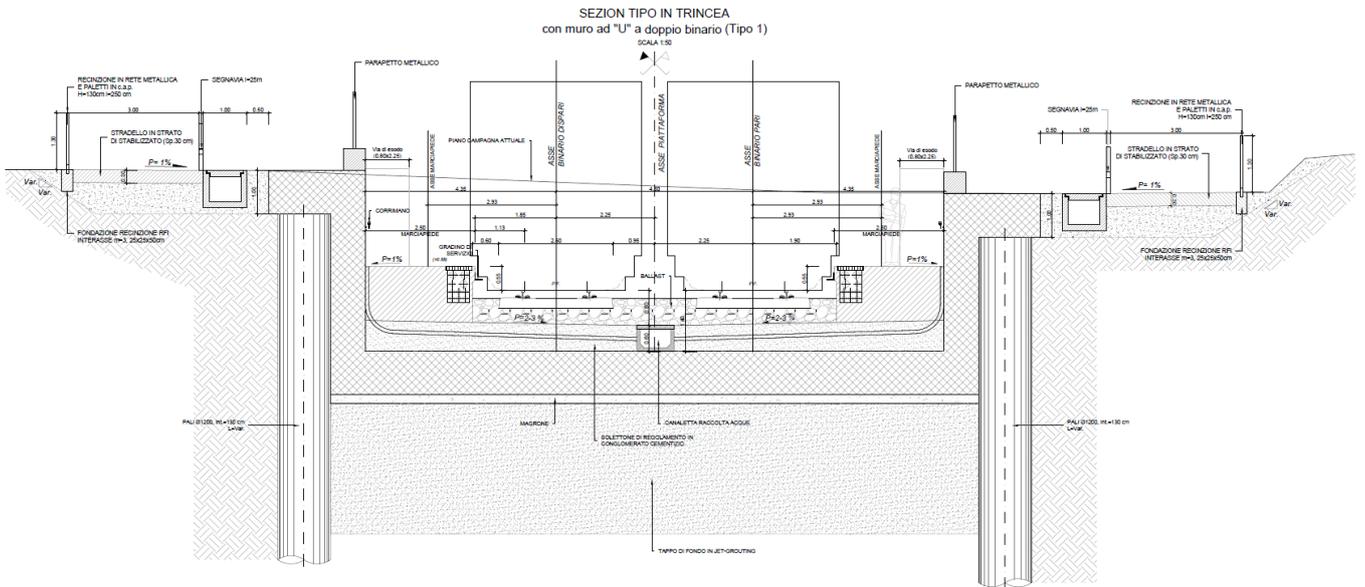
Sezione tipo in trincea a doppio binario con muro ad U (tipo 1)
